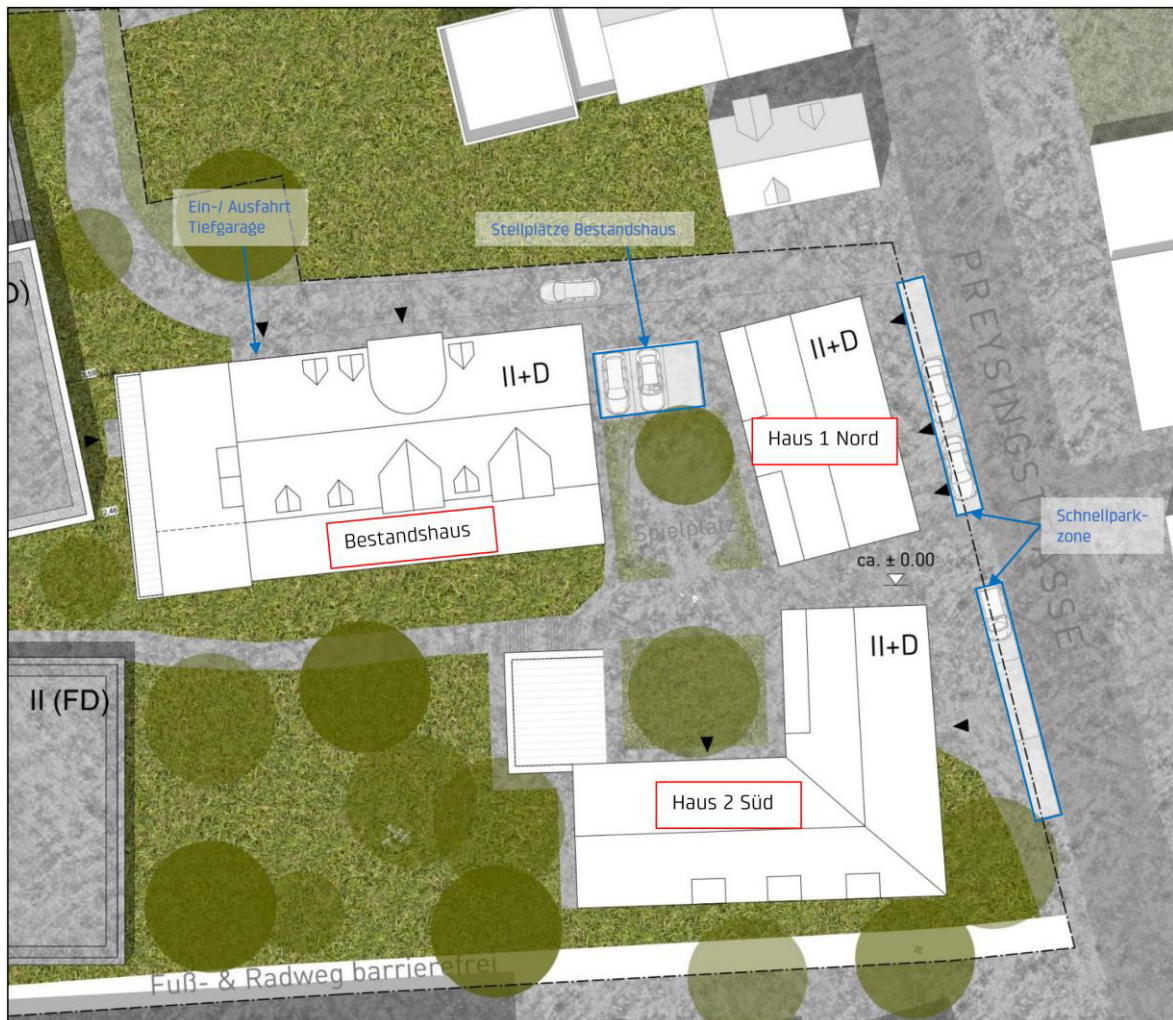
Lageplan mit Darstellung der Wohn- und Geschäftsgebäude
